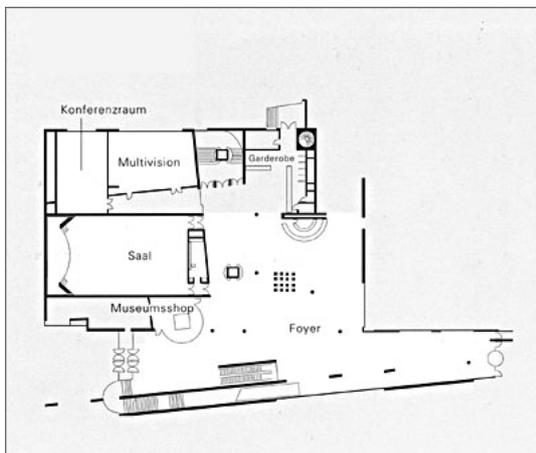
4: HDG – Grundriss Erdgeschoss
